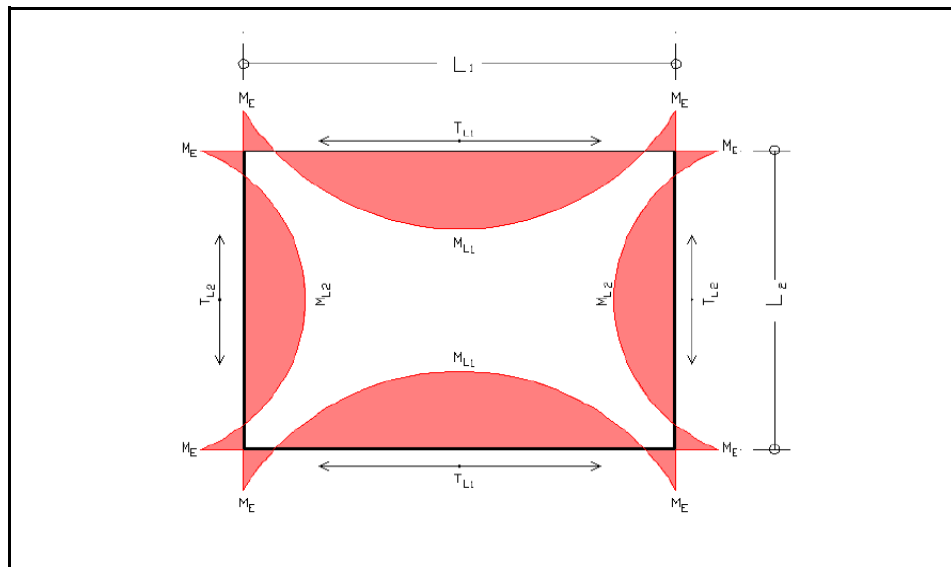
Modelo de pórticos en “U” para unión rígida fondo – losa en la estructura de una piscina.
